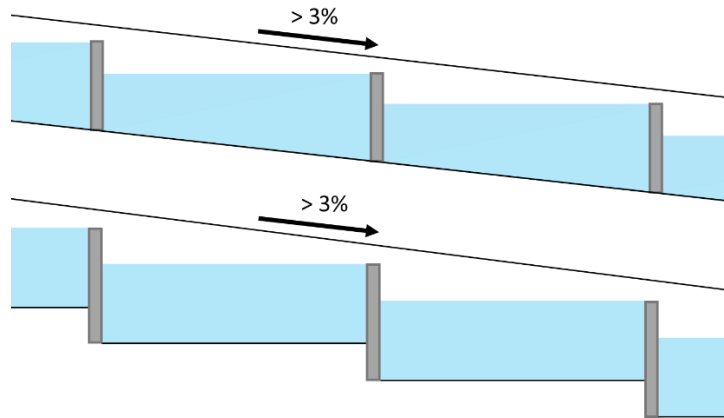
Ejemplo de cómo aterrizar la base del pavimento permeable.
